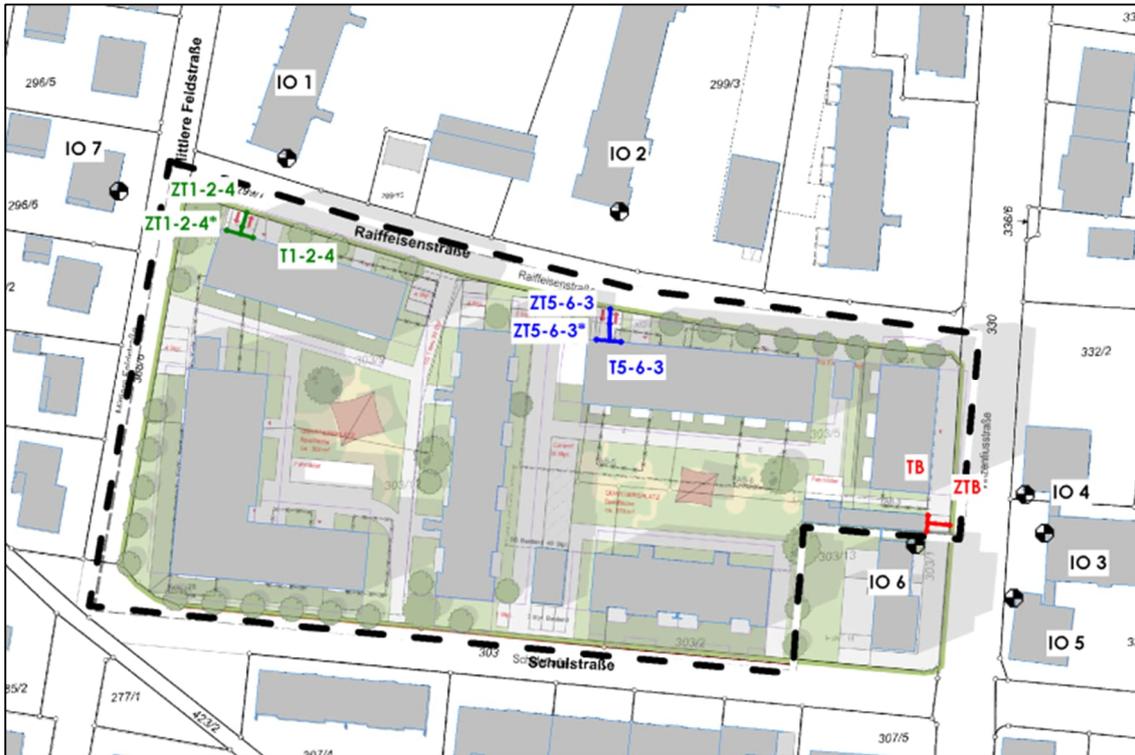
Lageplan mit Darstellung der relevanten Schallquellen /20/
